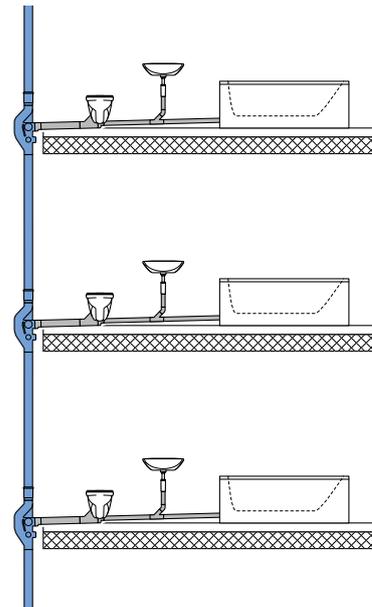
Einplanen eines Geberit PE Sovent Formstücks pro Stockwerksanschluss
